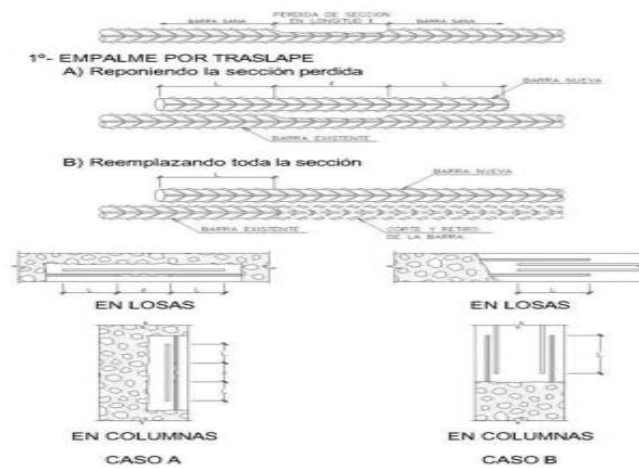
Tratamiento de reparacion y proteccion del hormihon y acero.
